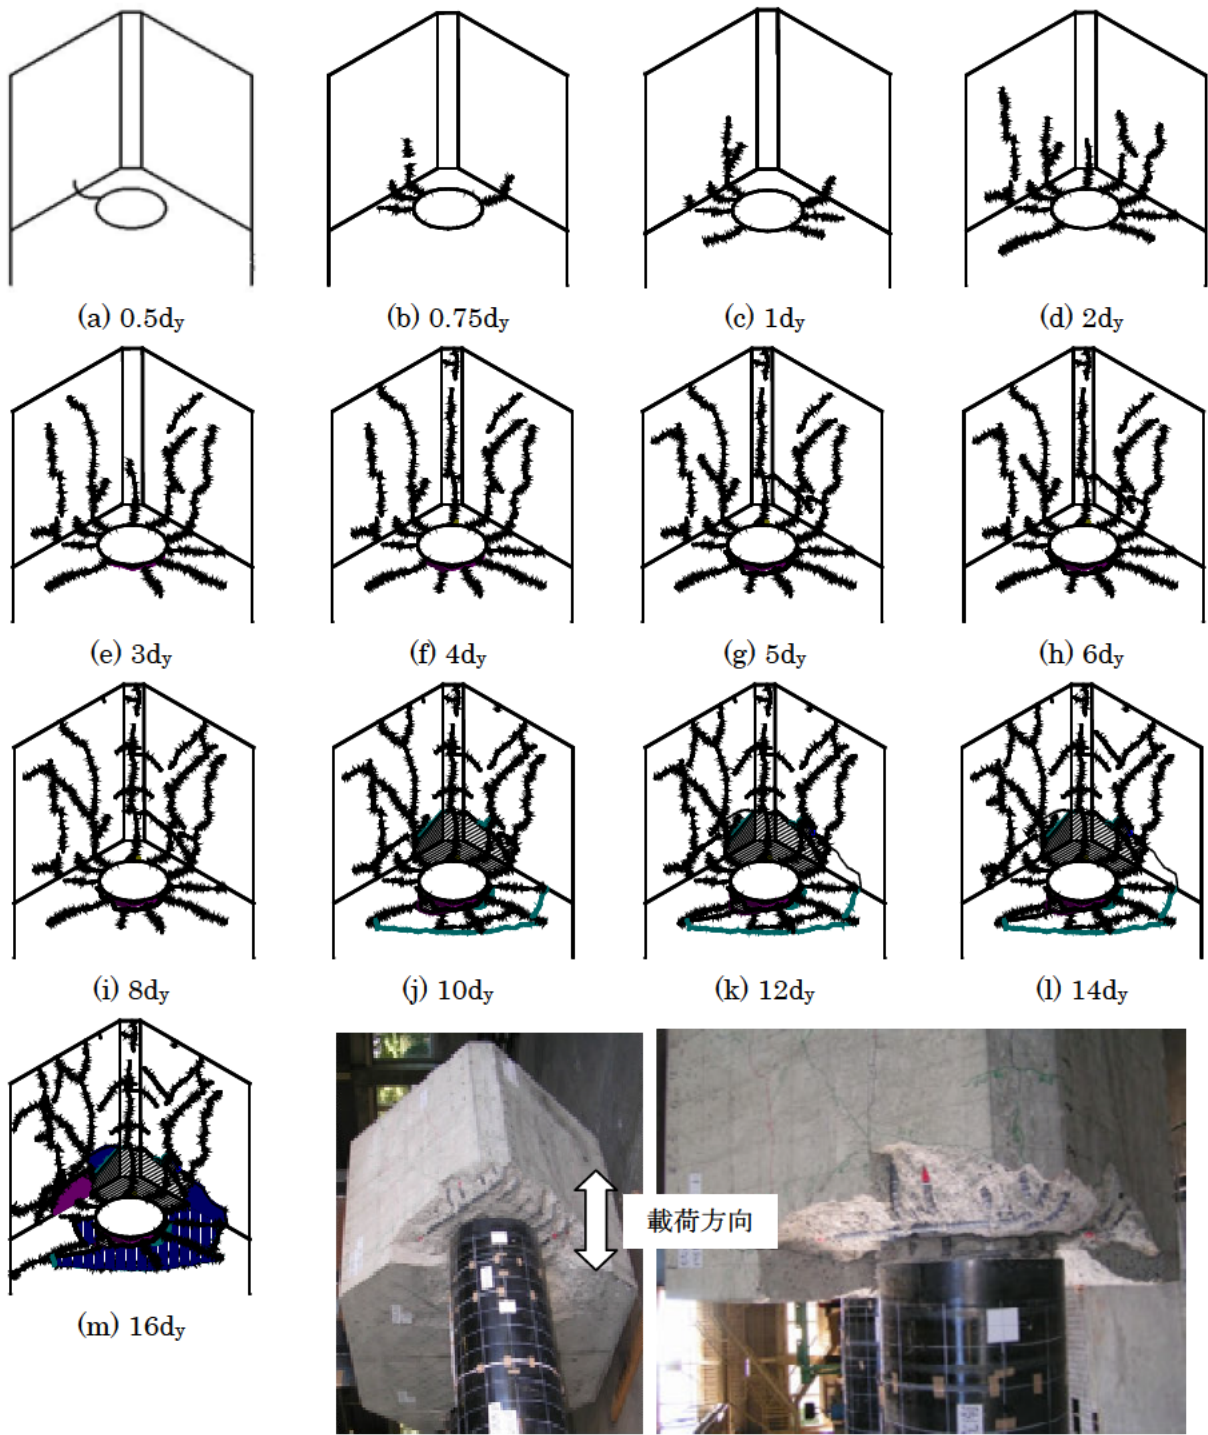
フーチング下面のひび割れ進行状況図 (Case SPP-C-1, PileA)
